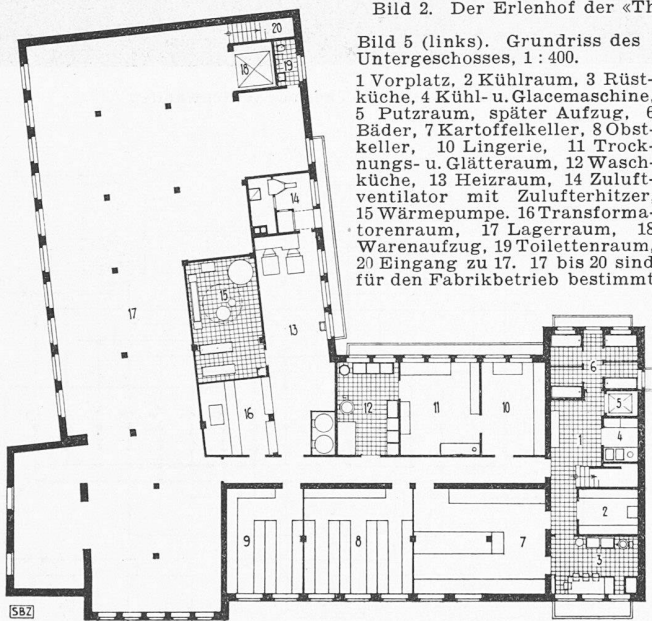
(links). Grundriss des Untergeschosses, 1 : 400.
